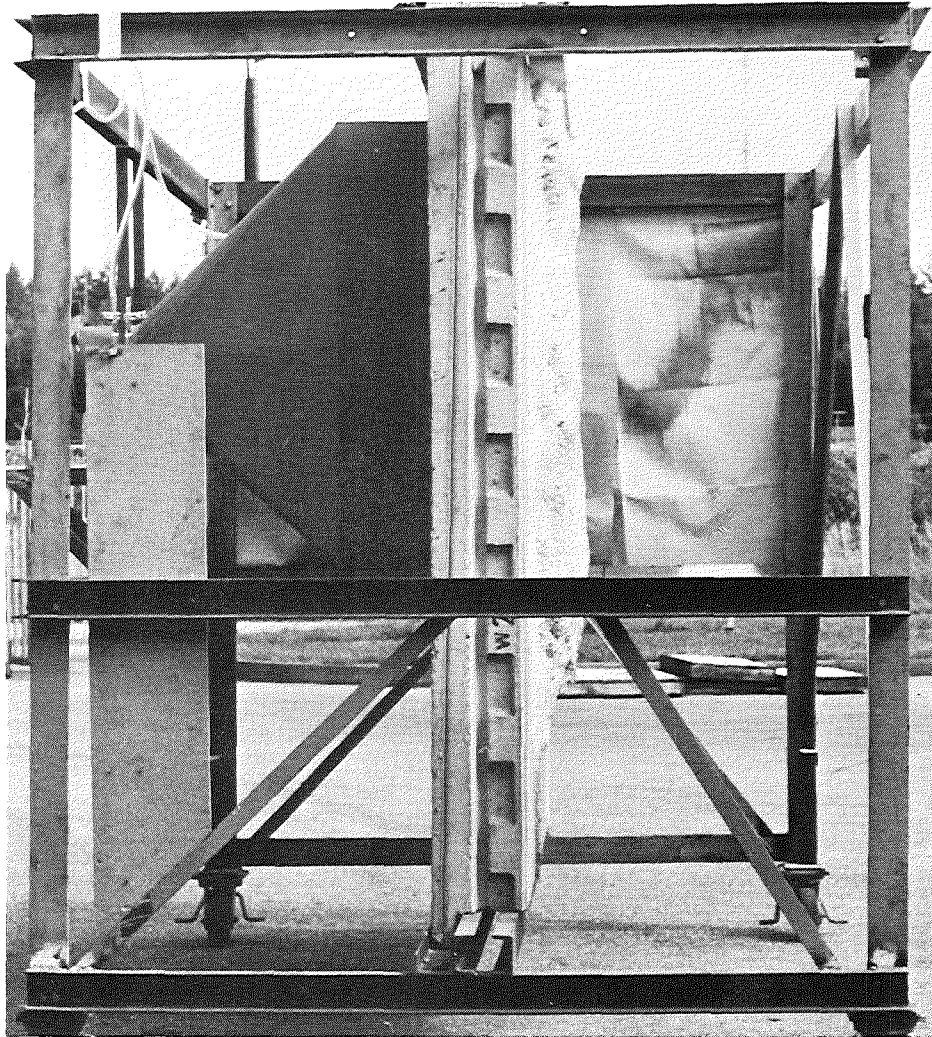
Mit Polyurethan-Schaum bei 80mm Wassersäule Unterdruck abgedichtete Betonöffnung 1,20 x 1,35m
